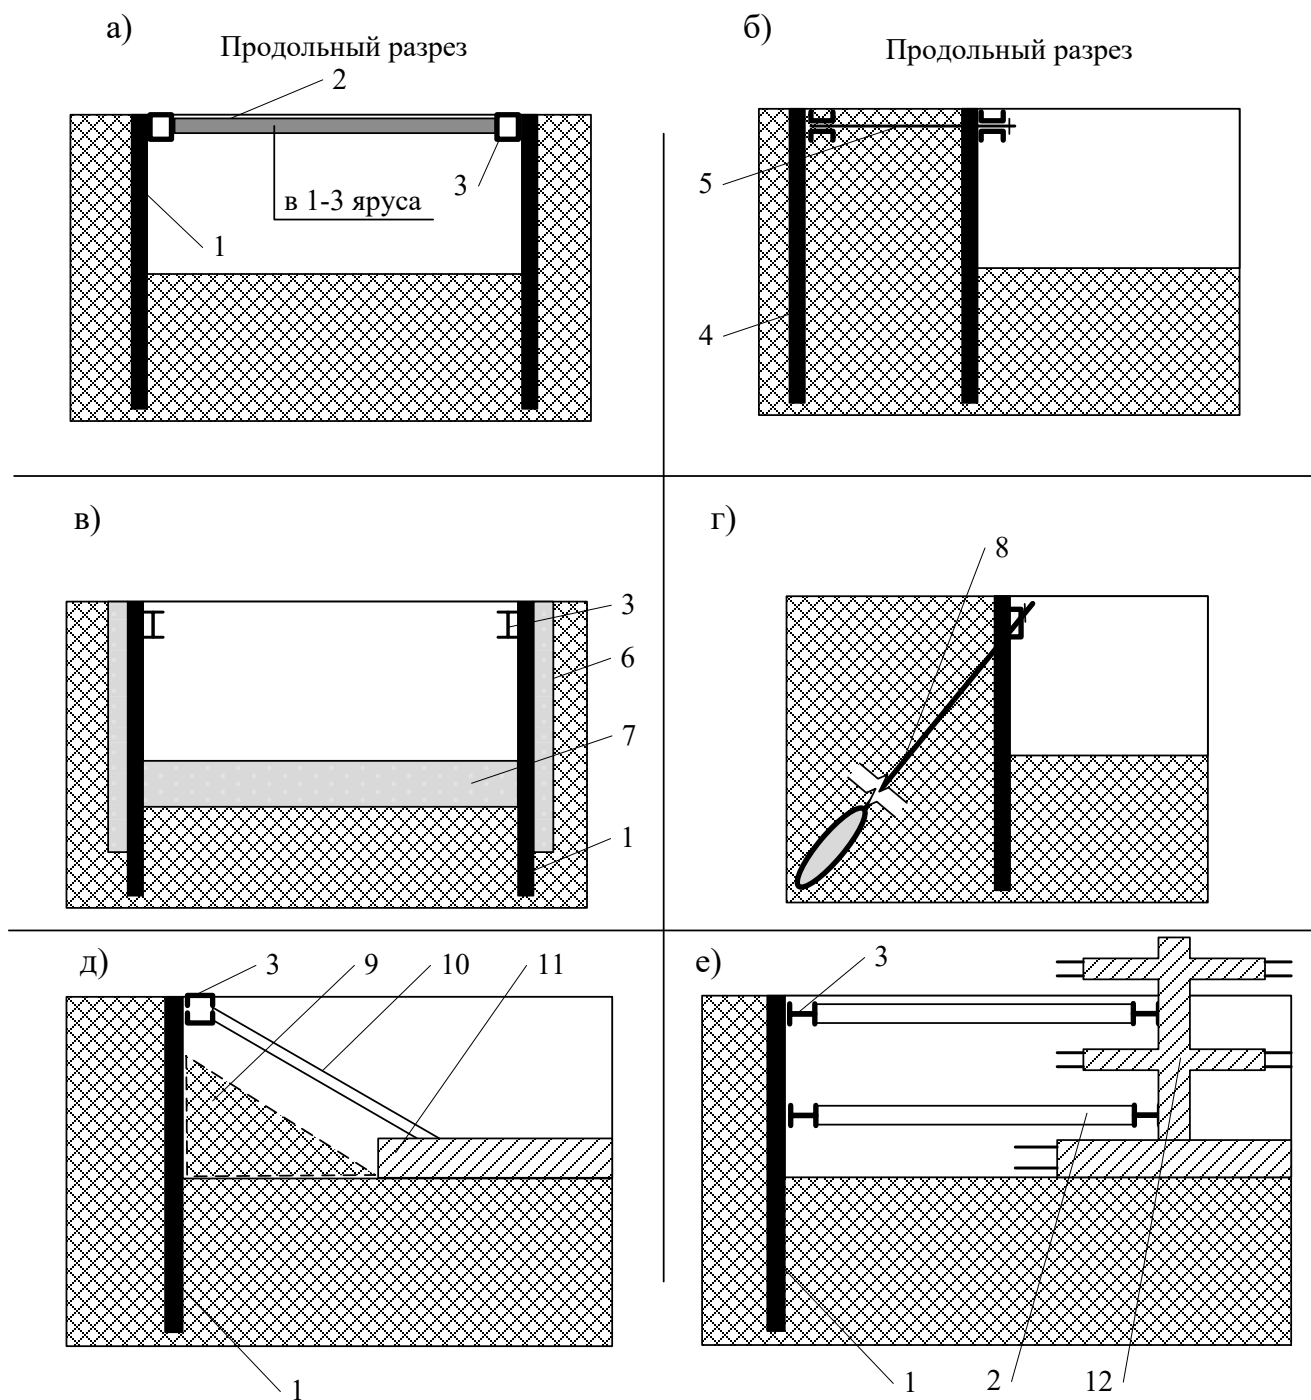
, начало – Конструктивно-технологические схемы устройства ограждений котлованов: *а* – с горизонтальными креплениями стальными балками; *б* – с анкерными стенками из шпунта; *в* – с грунтоцементными диафрагмами; *г* – с грунтовыми анкерами; *д*, *е* – соответственно с грунтовыми бермами на этапе устройства котлована и возведения ограждений подземного этажа; 1 — элемент ограждения котлована; 2 – горизонтальные стальные балки; 3 – распределительный пояс (обвязочная балка); 4 – анкерная стенка из шпунта; 5 – стальные анкерные тяги; 6, 7 – вертикальный и горизонтальный грунтоцементный массив; 8 – грунтовый анкер; 9 – временная, грунтовая берма; 10 – стальной подкос; 11 – фундаментная плита; 12 – несущие конструкции подземного этажа
